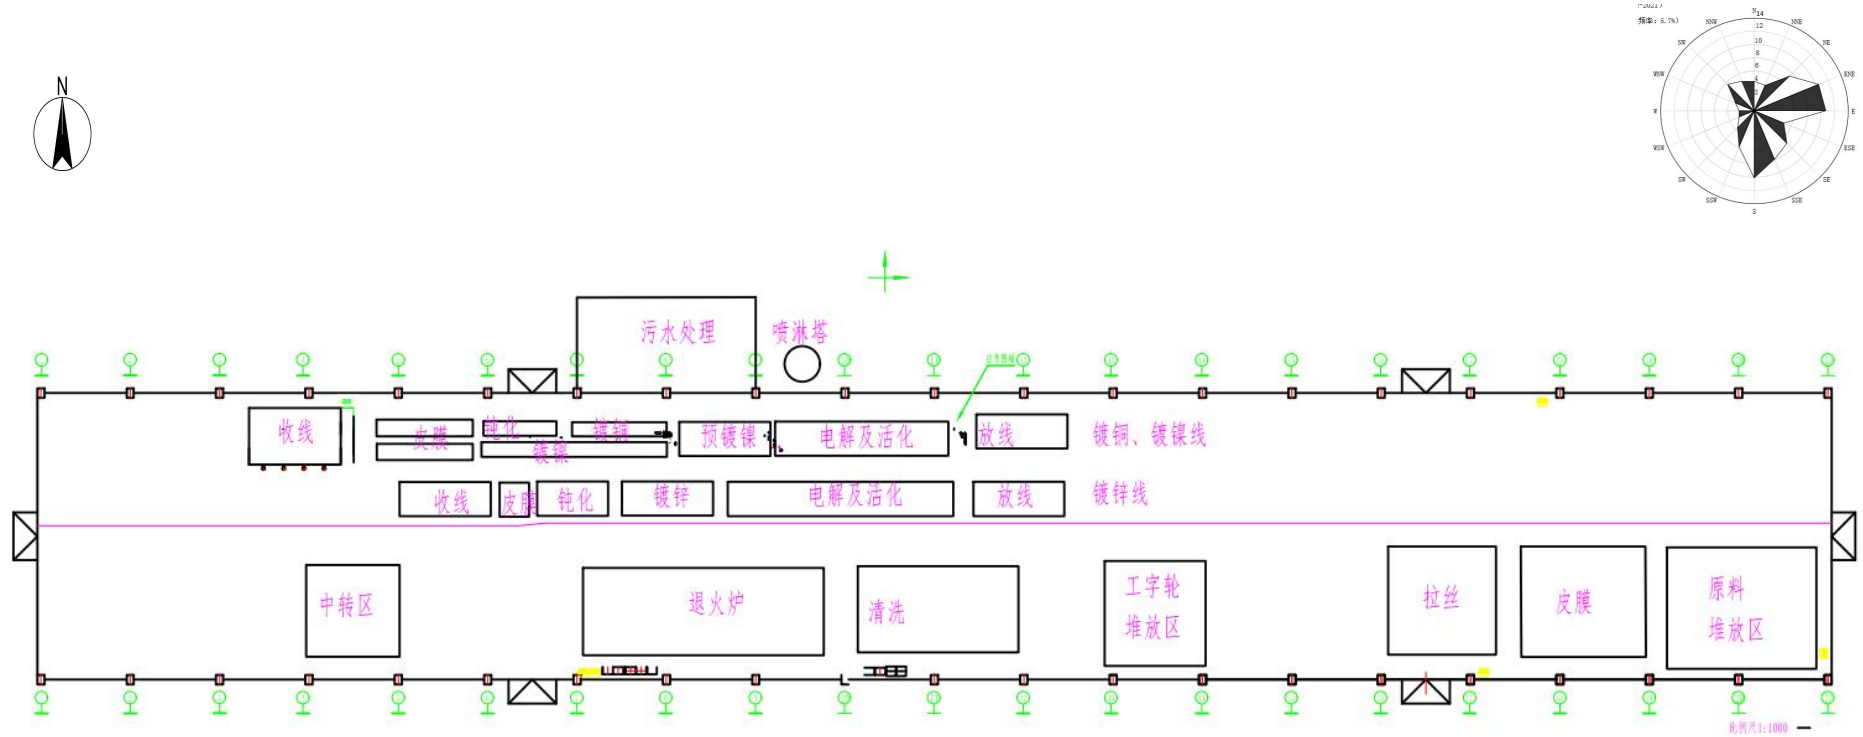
(2) 铬不锈钢车间内生产线平面布置图 (比例尺 1:100)
